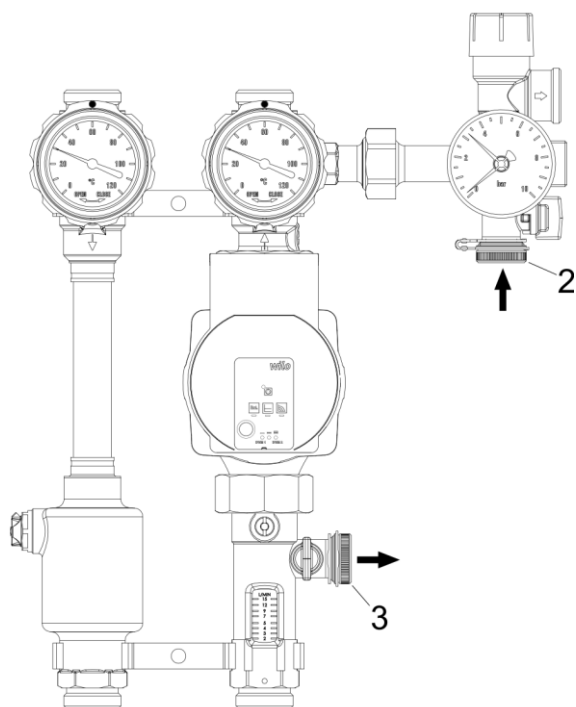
Anlage spülen: Anschlüsse - Detail
